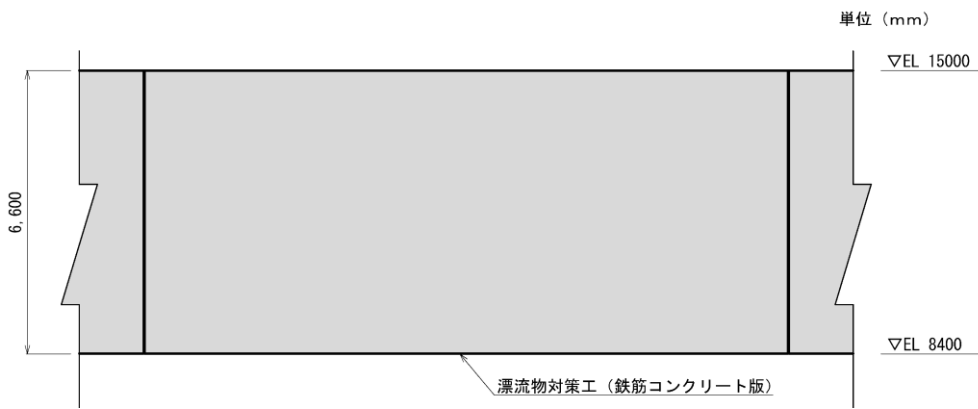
(2) 漂流物対策工(鉄筋コンクリート版)の構造概要図(正面図)
